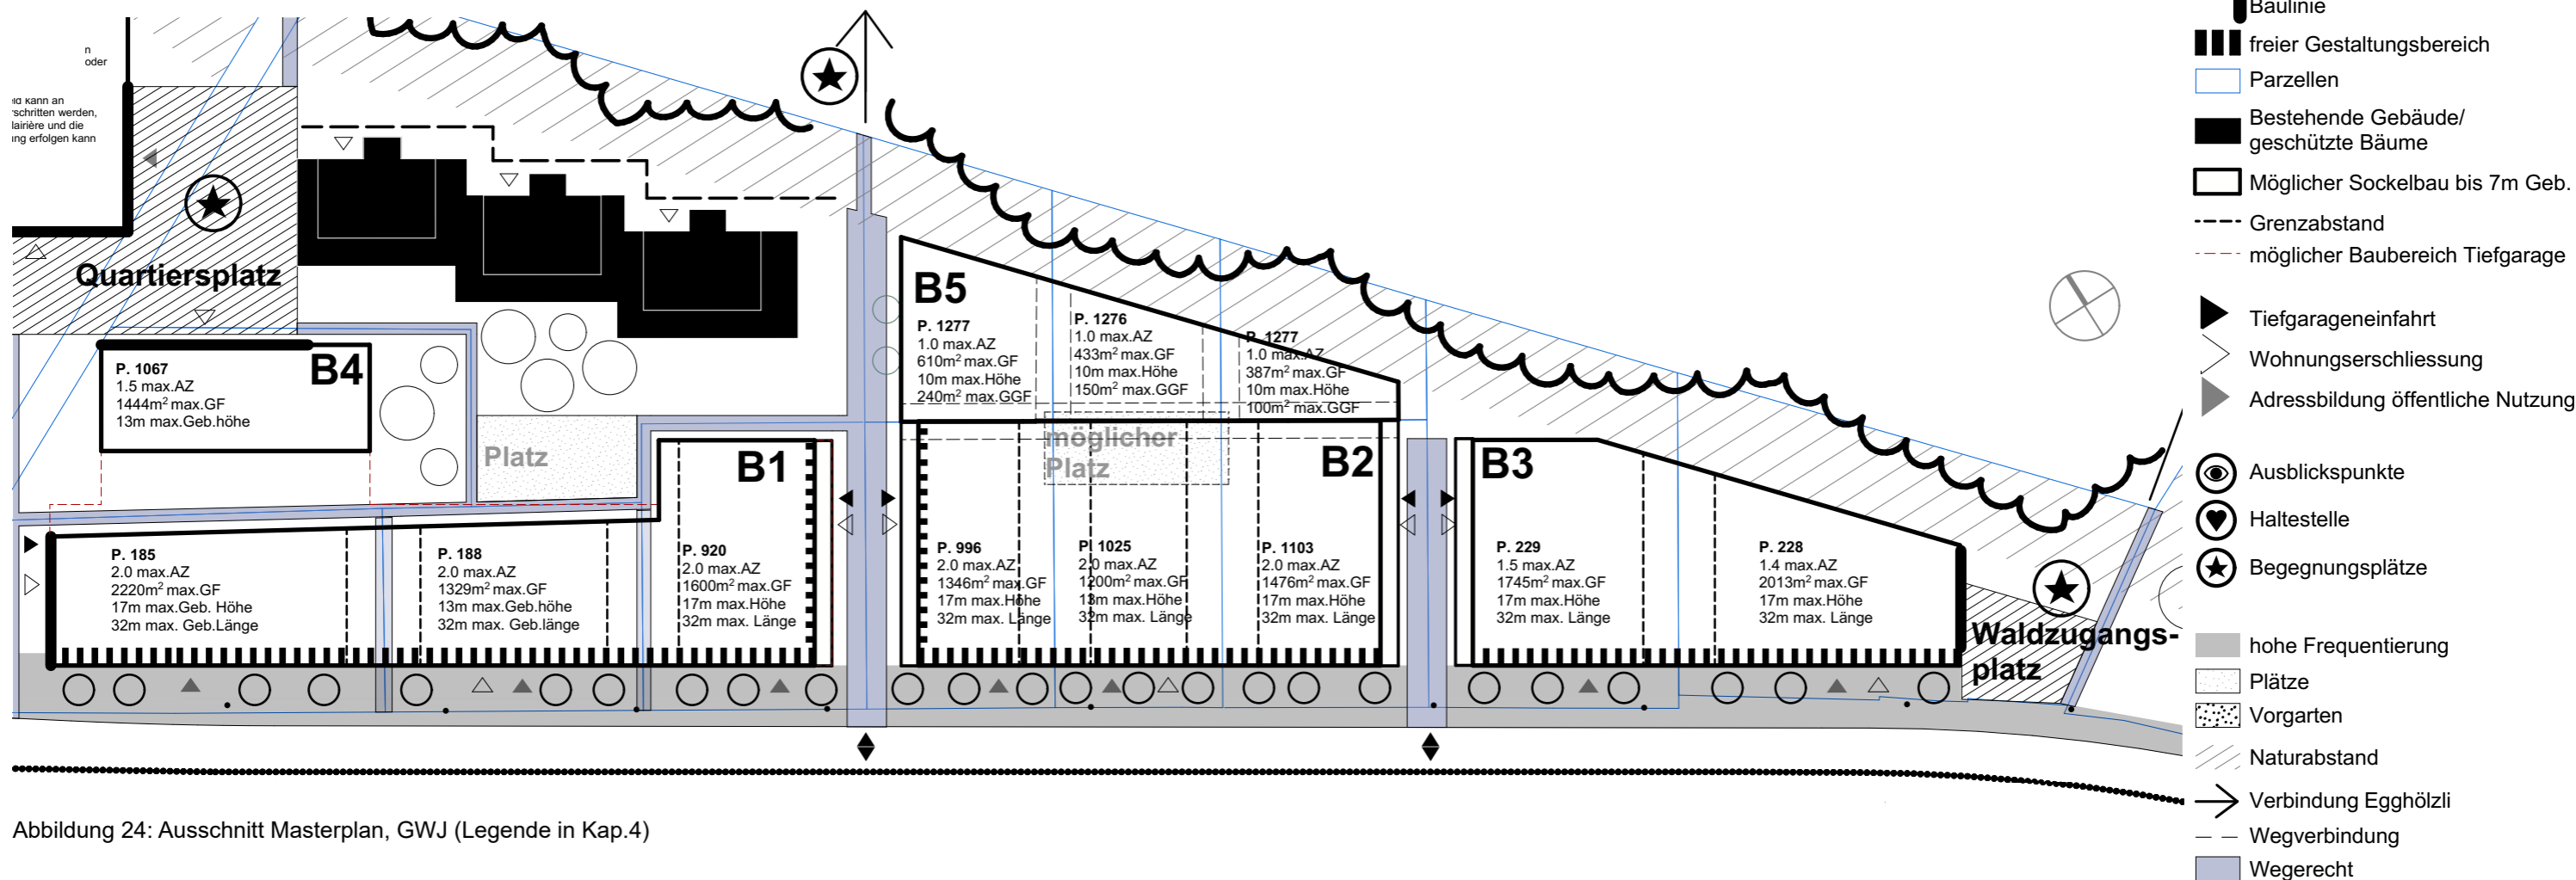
Ausschnitt Masterplan, GWJ (Legende in Kap.4)
